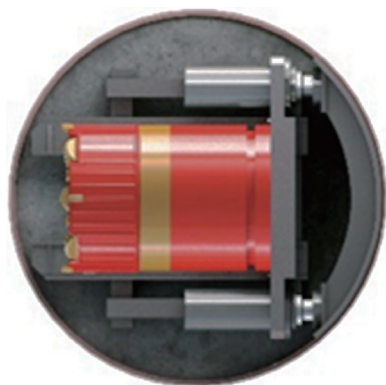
ケーシング立坑発進型の平面図（掘進機長L=2.0m）
